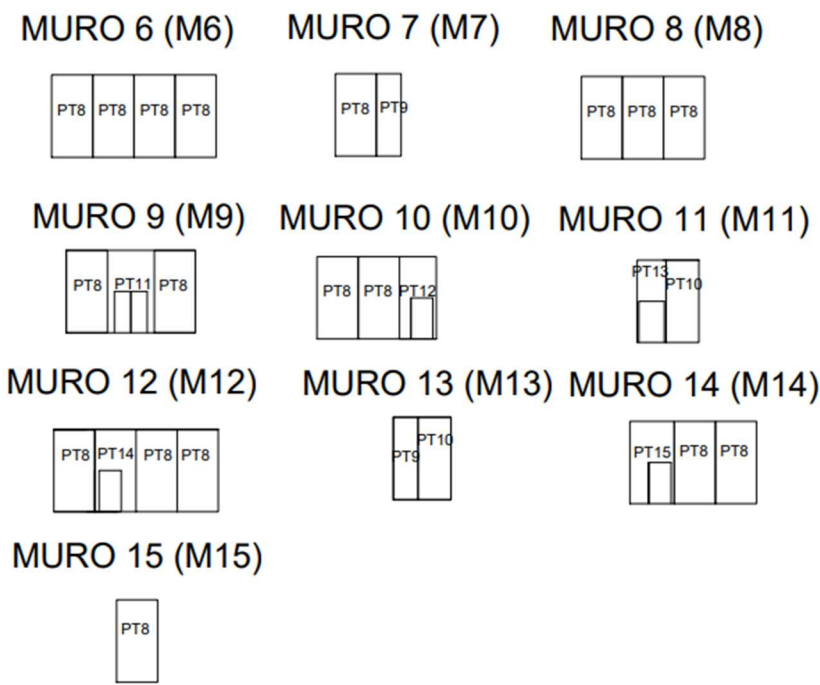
Tipos de paneles para muros. 2023 imagen: Lucero Gómez
